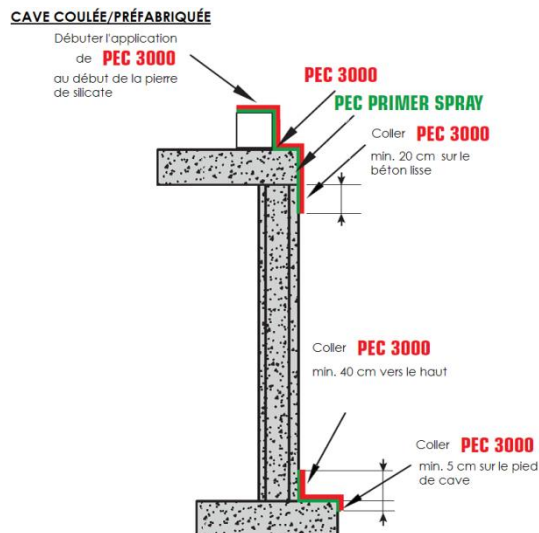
Application sur caves en béton coulé ou préfabriqué
